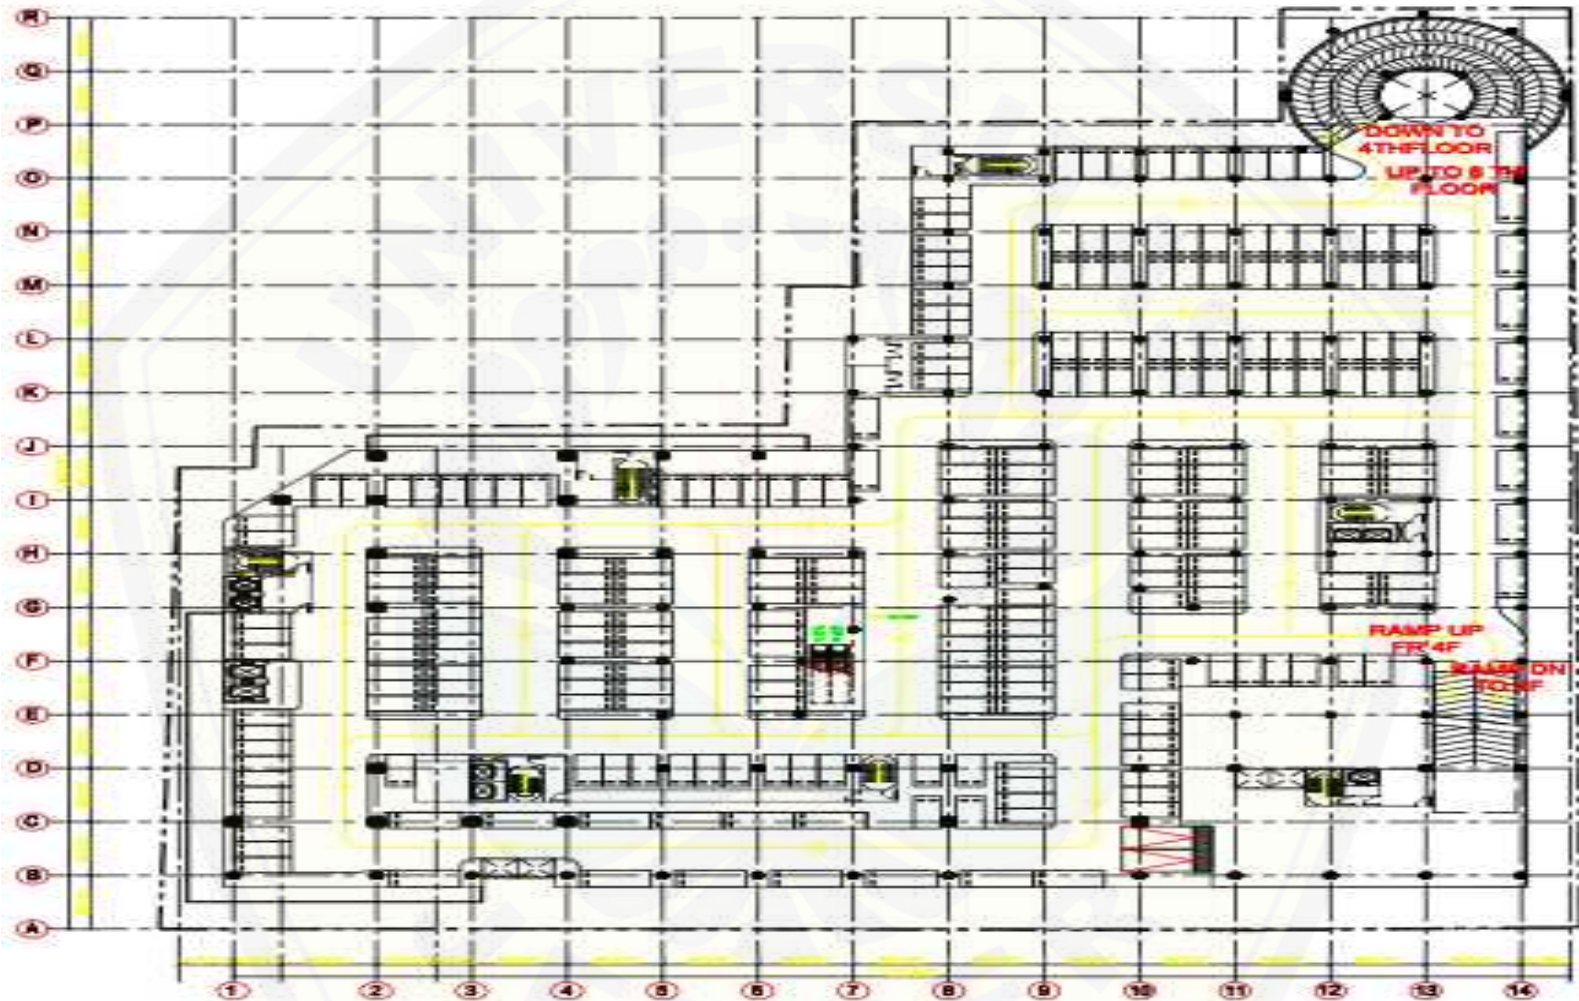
Perencanaan Lahan Parkir Lantai 3 oleh Pihak Pengembang
